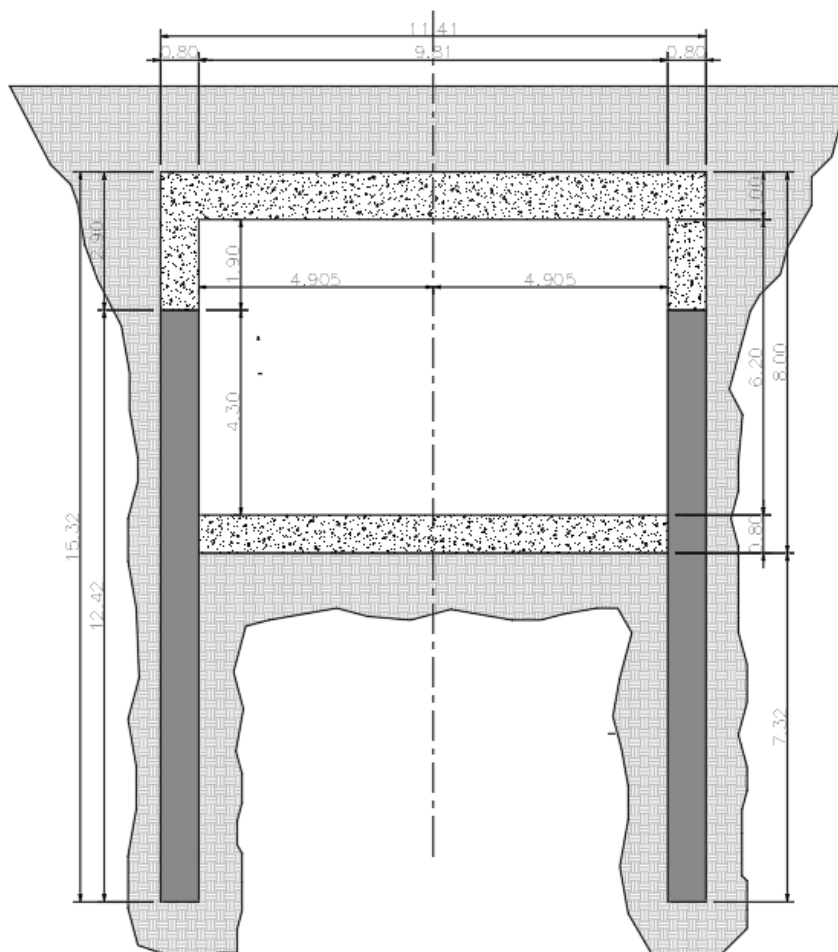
Sezione trasversale galleria artificiale GA02-GA3
